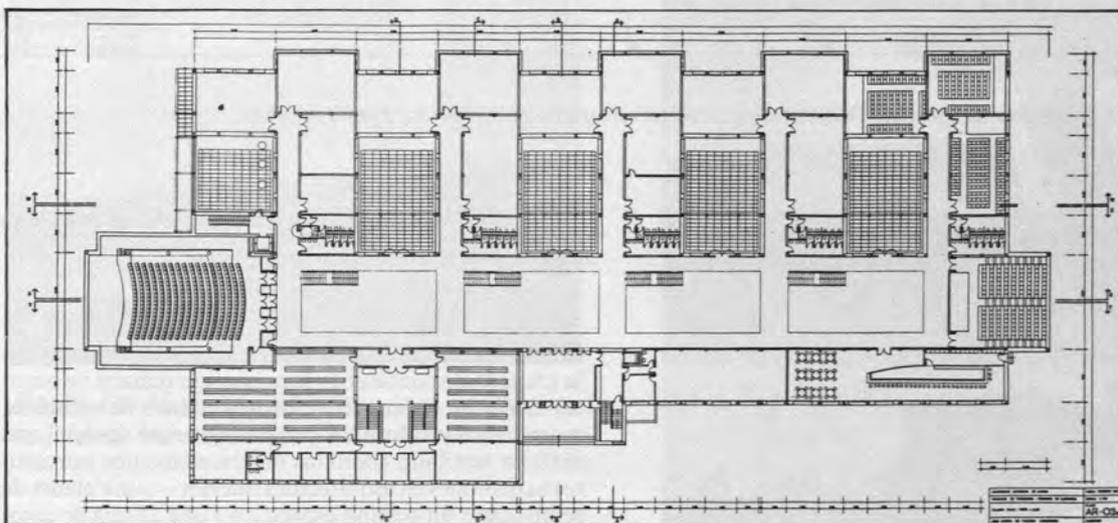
José M. García de Paredes: Facultad de Psicología. Proyecto de ejecución. Planta baja.
